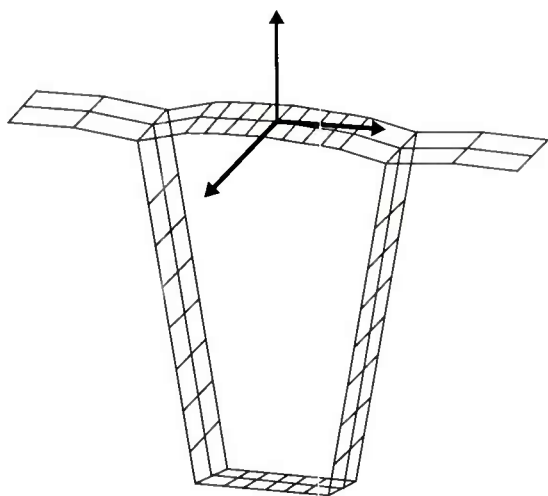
Modélisation d'un demi-voussoir sur pile par un modèle 3 D (extrait avec 3 plans seulement pour plus de lisibilité)
